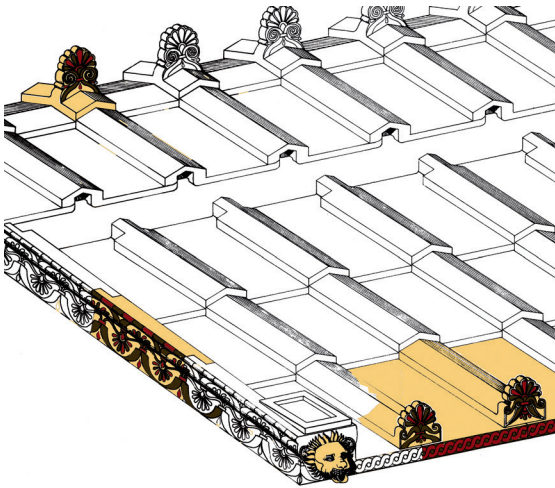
Trapezá Aigiou, Rekonstruktion des Daches
